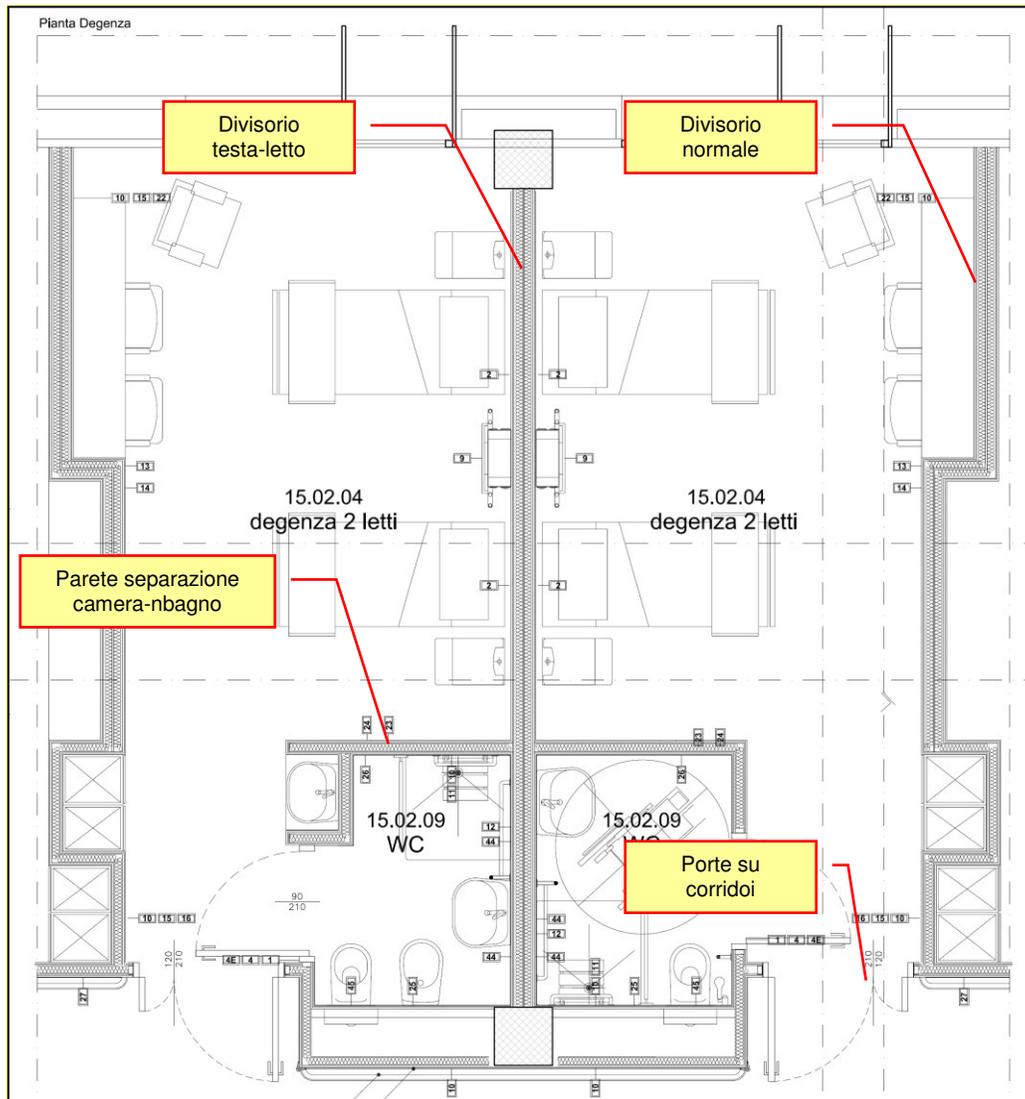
Camera di degenza: “pianta tipo”
